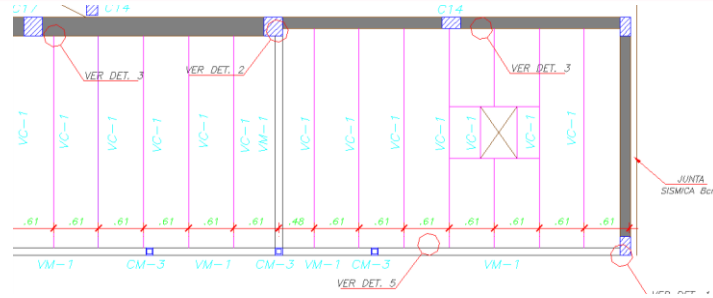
Estructura Metálica - Plano de Techo Metálico.
